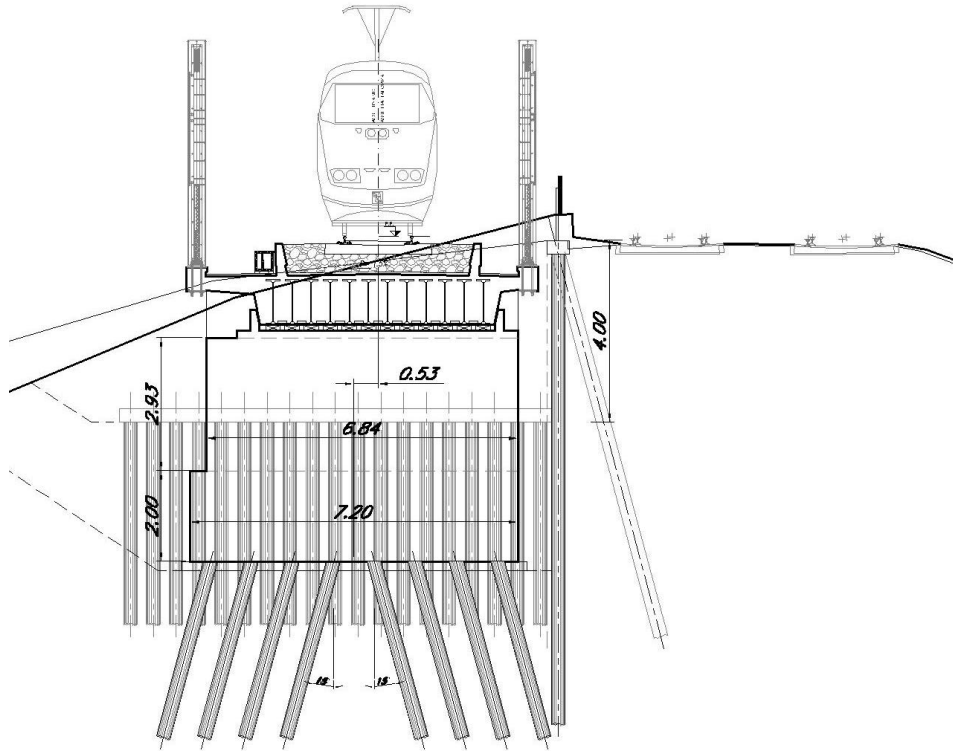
Spalla A – paratia di micropali a cavalletto per realizzazione spalla – sezione trasversale B
